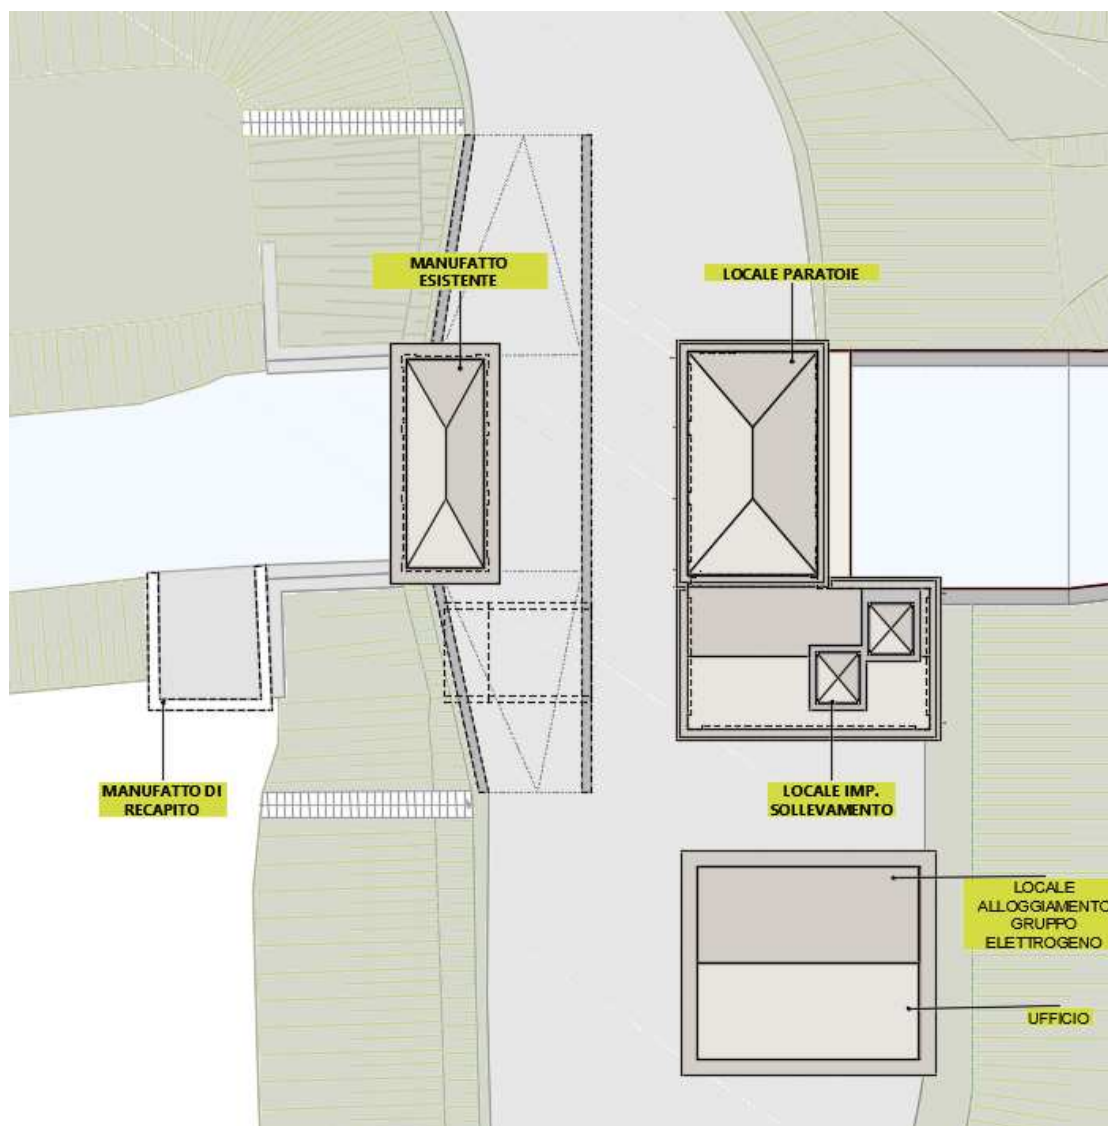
Planimetria funzionale delle strutture di ampliamento del sistema di regolazione del nodo idraulico
